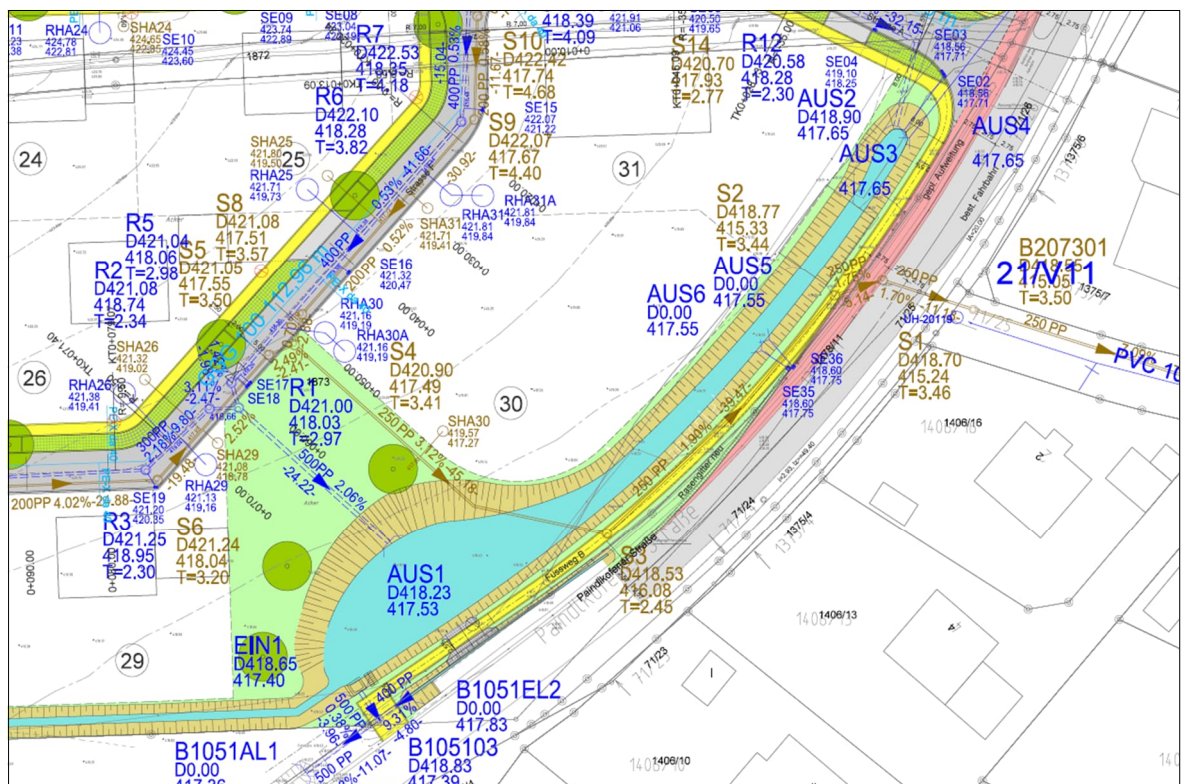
Ausschnitt Lageplan Kanalbau, IB Ferstl
